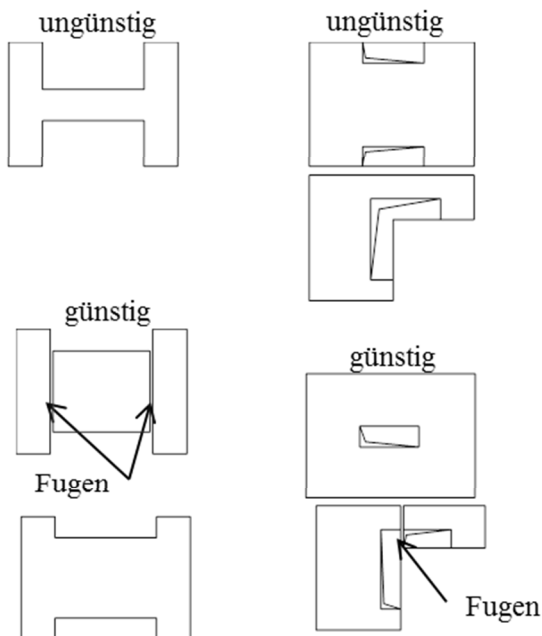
Maßnahmen im Grundriss [7]
